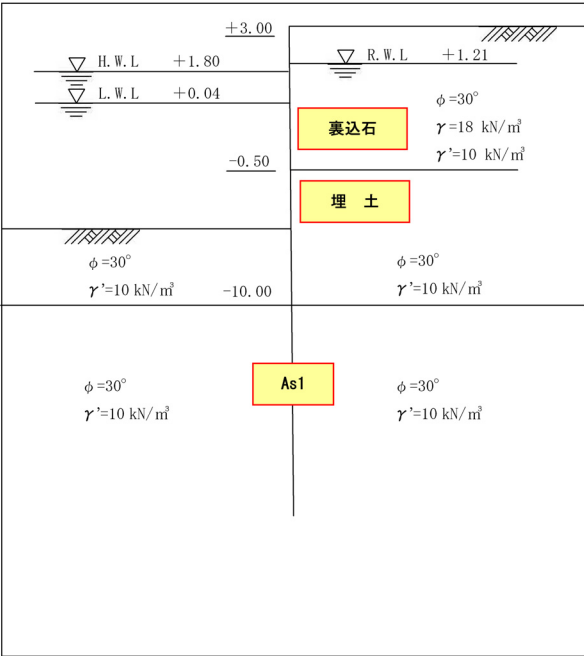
地盤モデル図 (A, B, C, F 断面)
